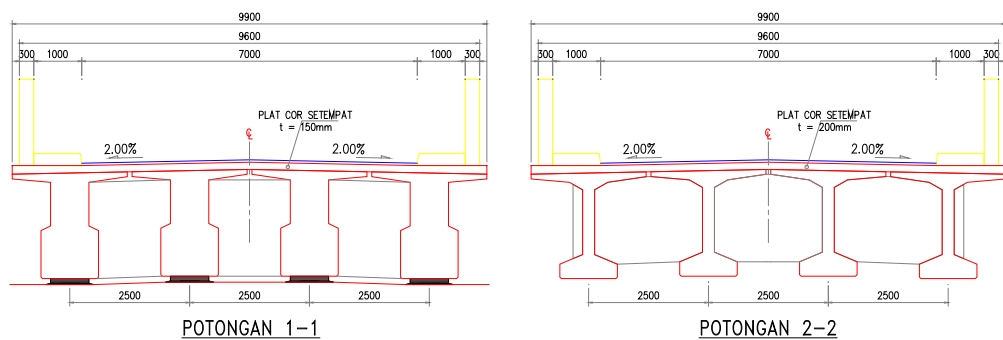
Denah Type Buld Tee Girder Perencanaan Jembatan Sei Rakyat
